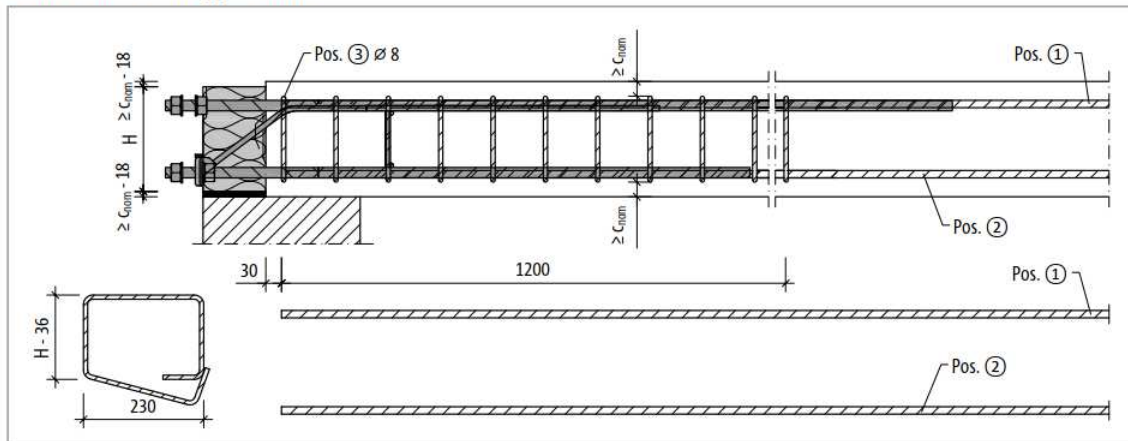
Schöck Isokorb® XT Typ SK-MM2: Bauseitige Bewehrung mit Bügel \varnothing 8 mm; Schnitt
